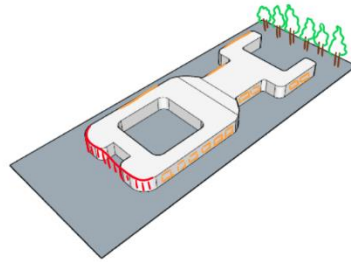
12 Perbedaan Zona pada Massa Bangunan
